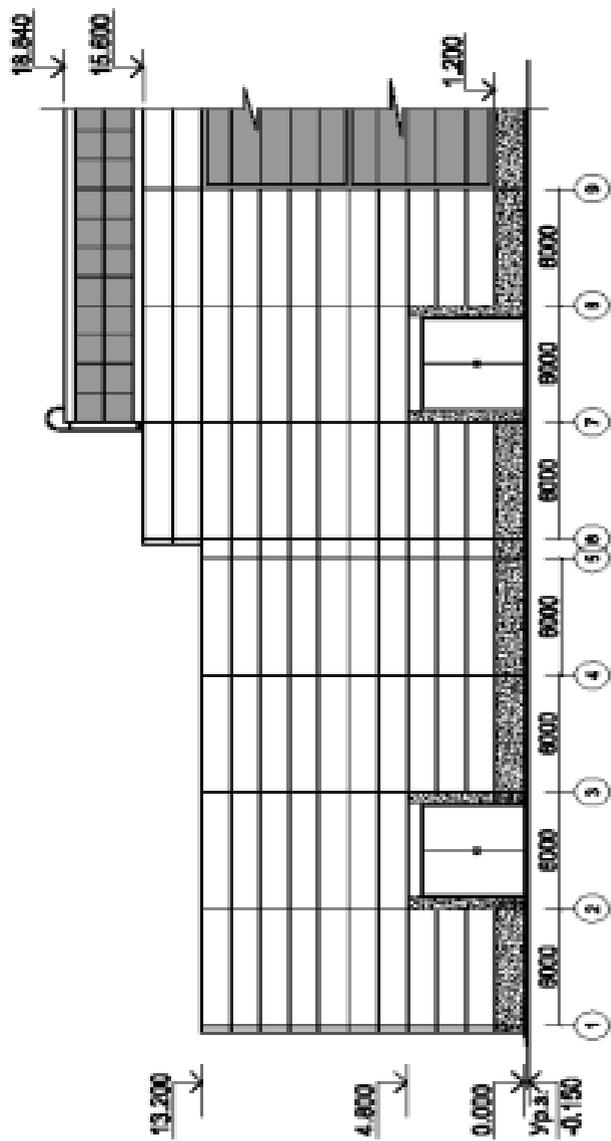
Фрагмент фасада со стенами из трехслойных железобетонных панелей
